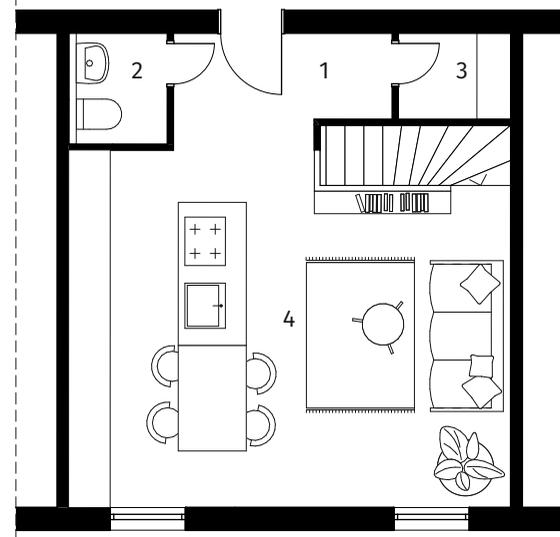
Grundriss Obergeschoss. M 1 : 100
